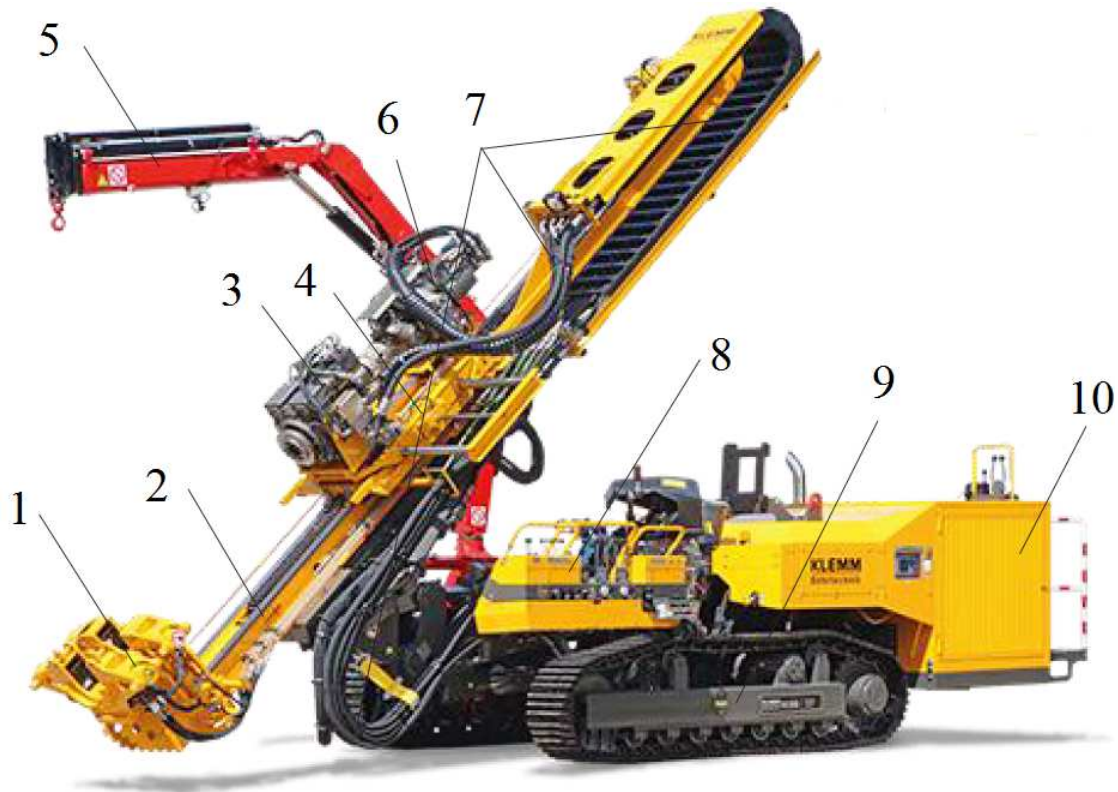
Самохідна бурова установка: 1 – затискач для з'єднання та роз'єднання труб; 2 – щогла; 3 – обертач бурового інструменту; 4 – ковзні салазки з цепним приводом подачі; 5 – маніпулятор для подачі бурових штанг; 6 – оборотний гідро-перфоратор; 7 – пучок гідравлічних шлангів; 8 – панель управління; 9 – гусеничне шасі; 10 – силова установка
